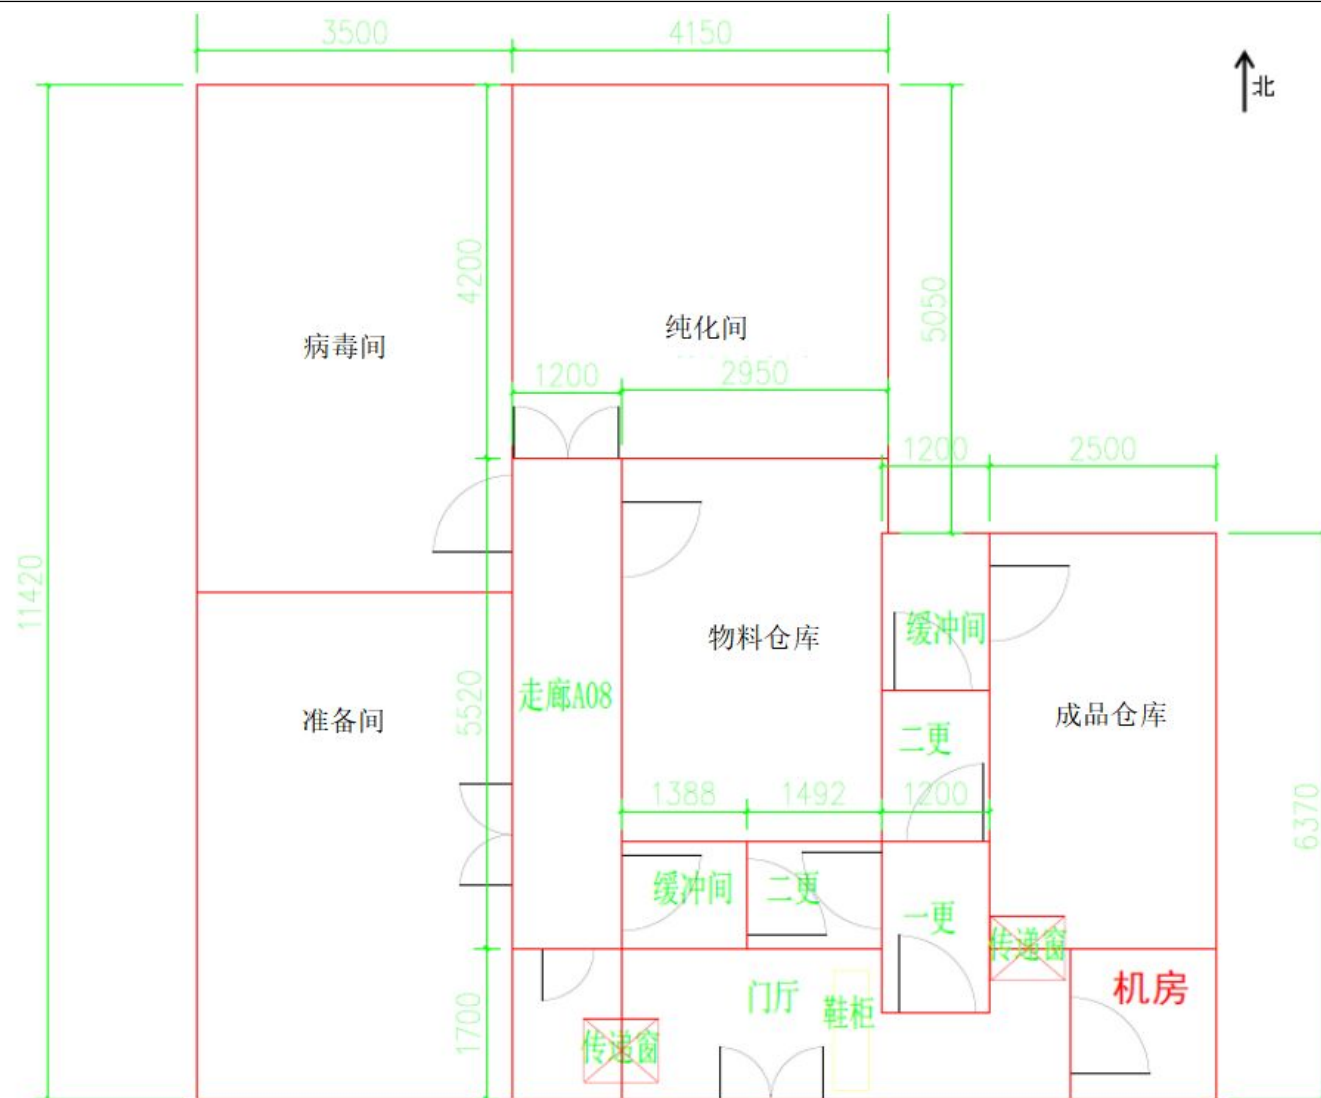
5 幢 1609 室 GMP Like 疫苗研发实验室平面布置图
